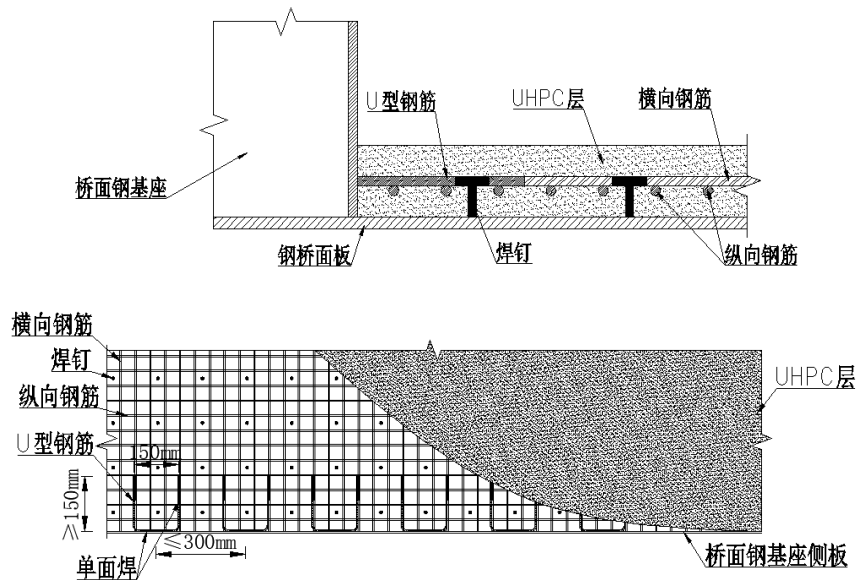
UHPC 层与钢结构连接示意图 (U 型钢筋连接)
